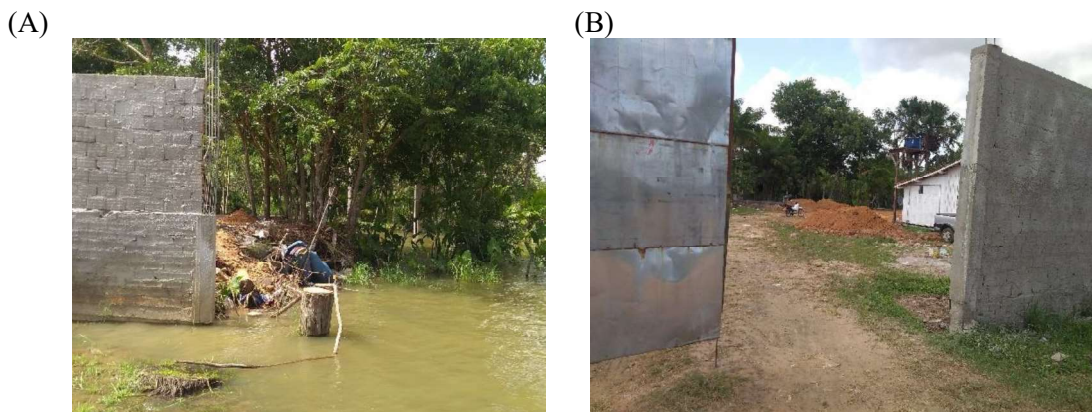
Ponto “P3”. (A) Visão geral da área visitada. (B) Construção em planície de inundação.
